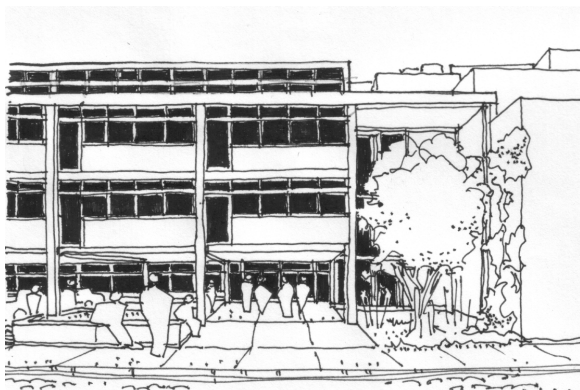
Acceso - Fachada Norte: Parasol y estante de luz.
